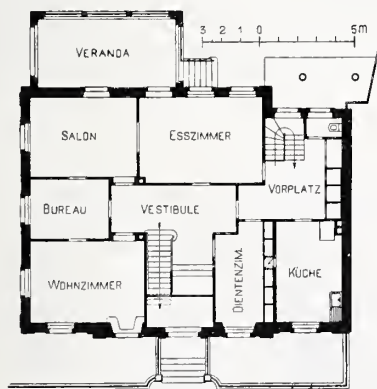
, 34 und 35. Grundrisse vom Erdgeschoss und den zwei Obergeschossen. — 1:400.
